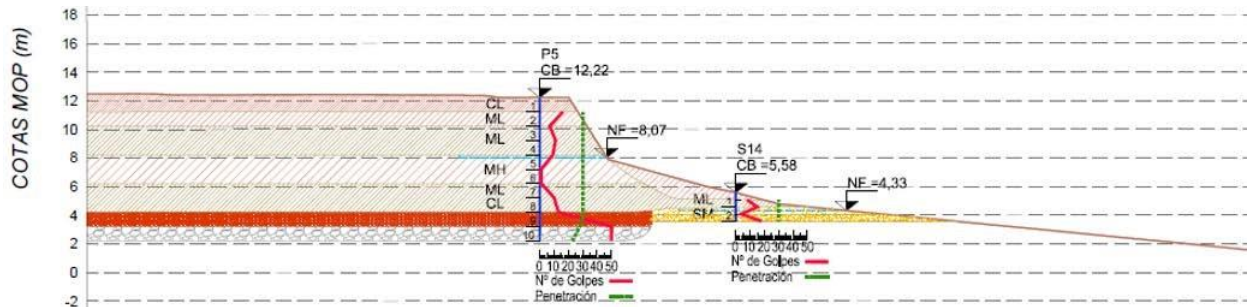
Perfil geotécnico en la zona del Pozo 5
